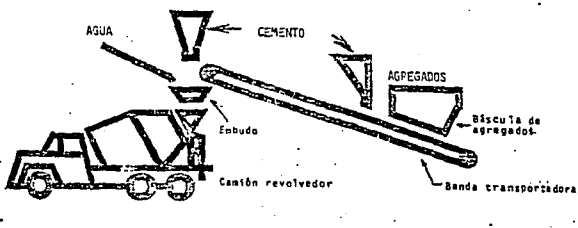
PLANTA DE CONCRETO CON MEZCLADO EN CAMION
